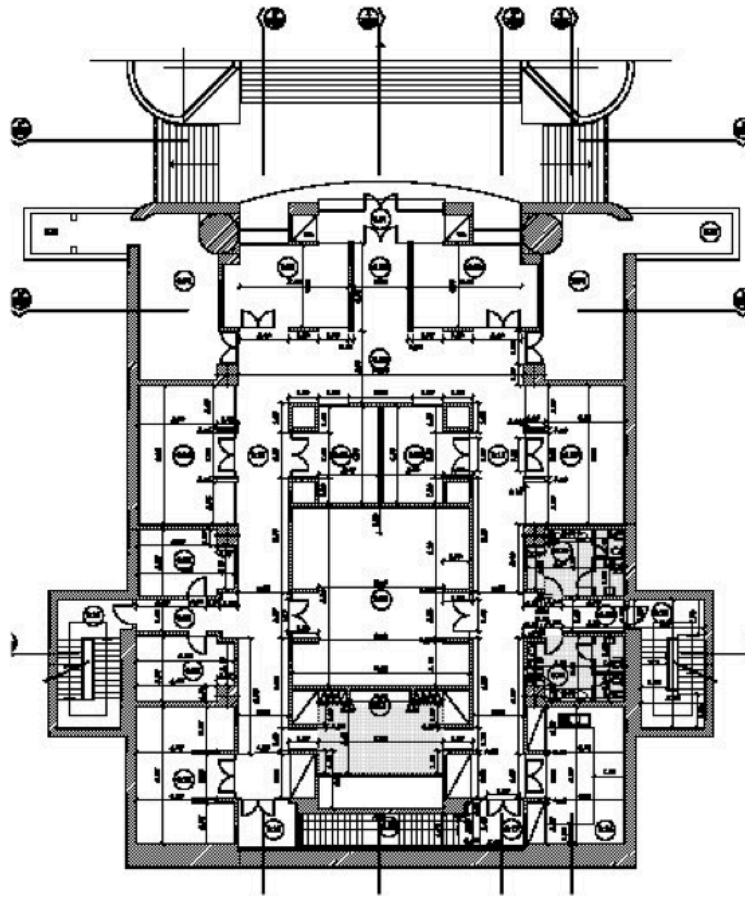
Planta do Piso 0 (Reservas, Administração)
